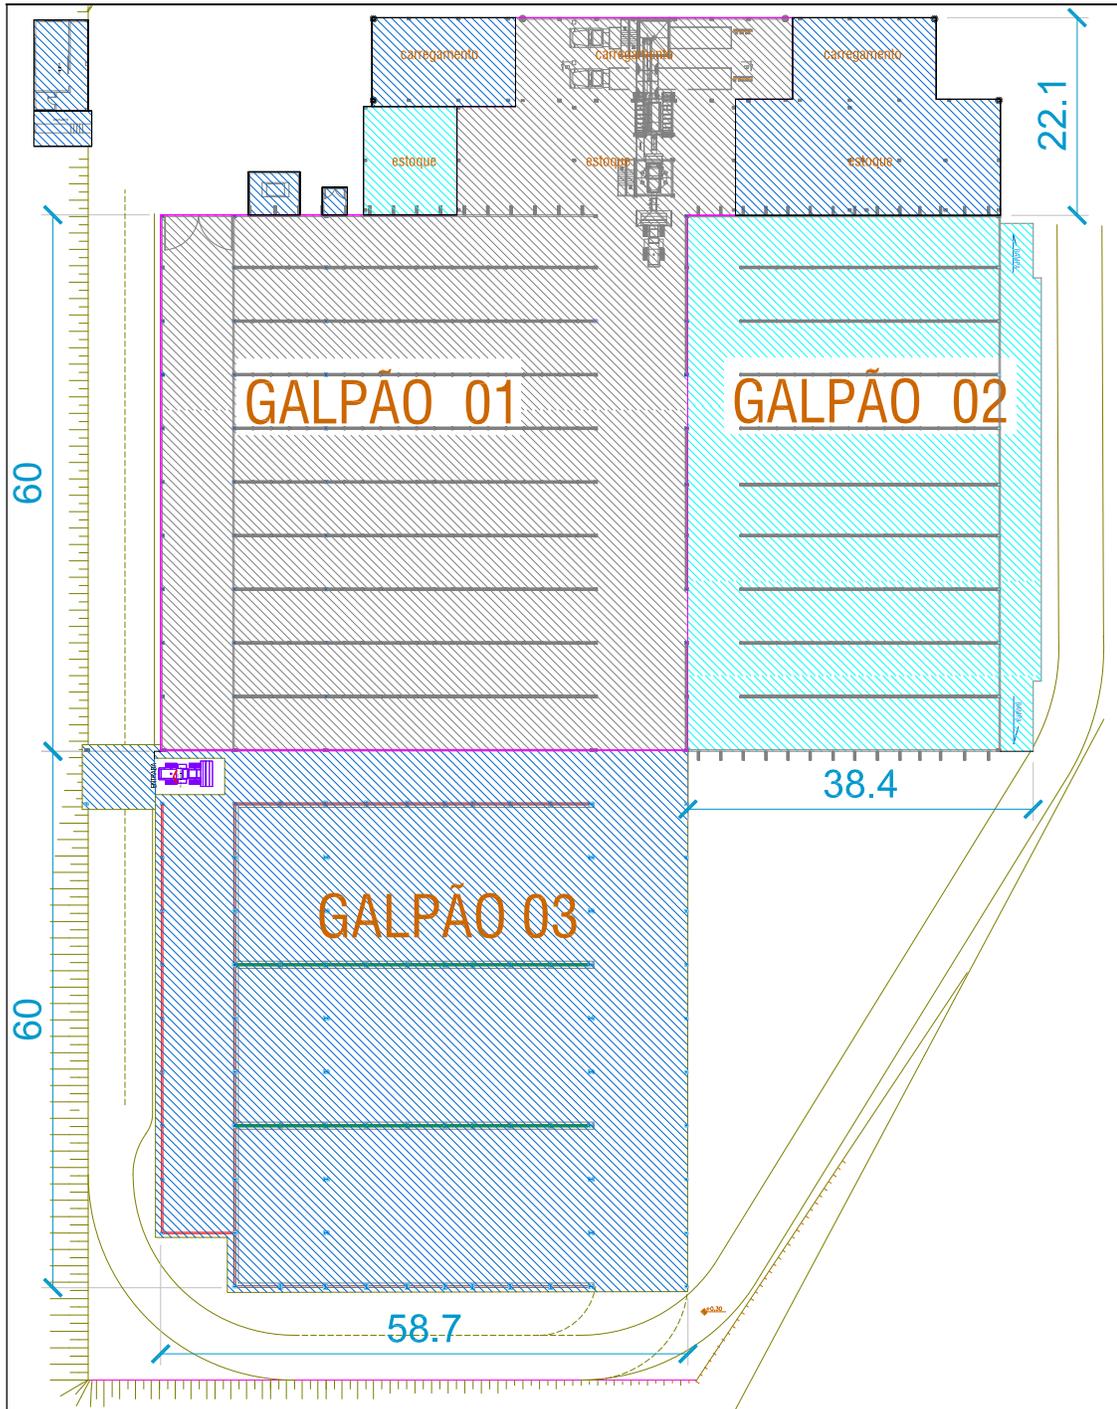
Planta baixa do Galpão 3 do caso C
